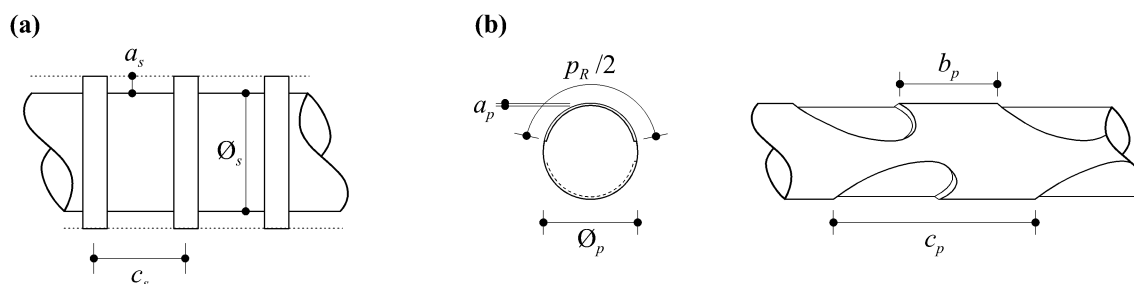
Profilierung von Bewehrung, Rippengeometrie – (a) Idealisierung eines Stabs aus Betonstahl und (b) Geometrie beim profilierten Spanndraht.
